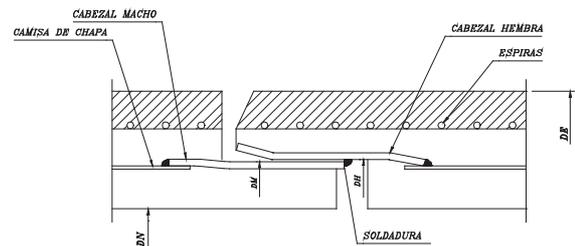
Tubería de hormigón postesado tipo DELTA.
